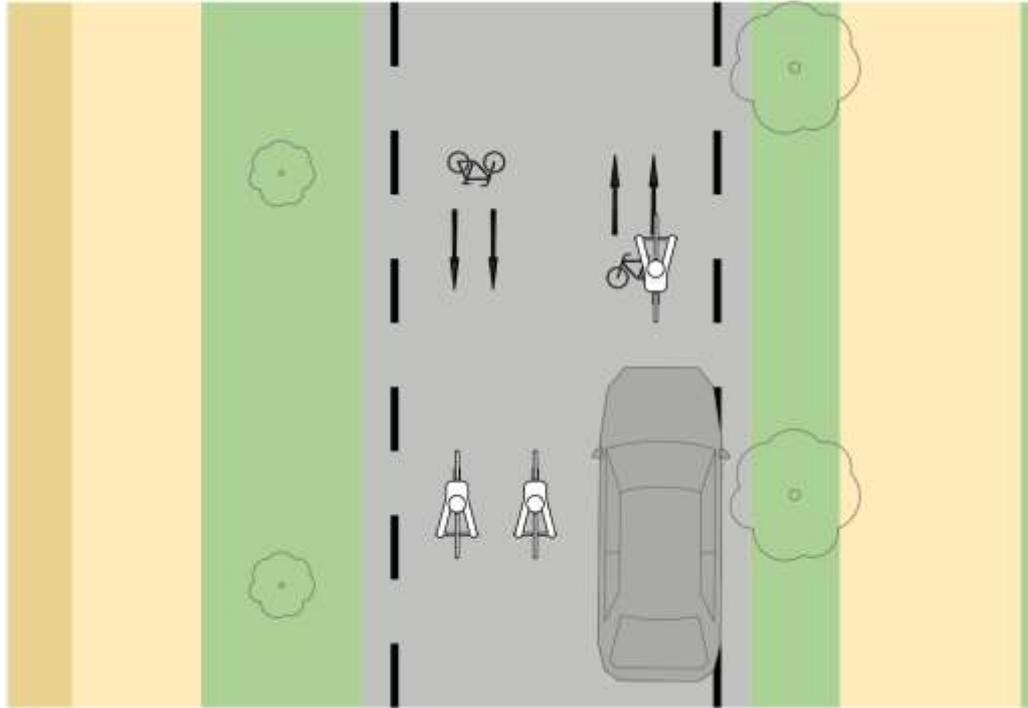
Empfohlener Straßenquerschnitt Römerweg
